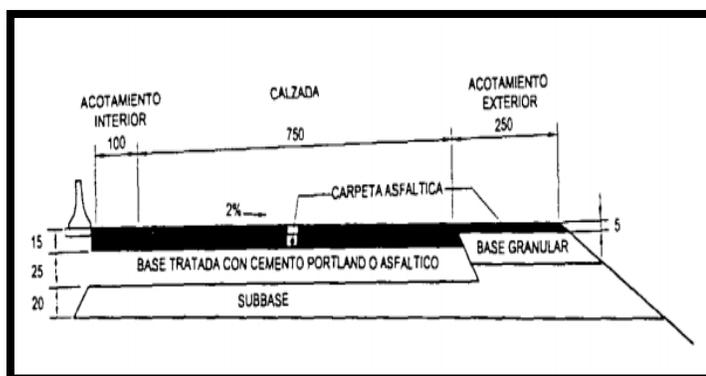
Pavimento para tránsito pesado (CDT, 2002)
